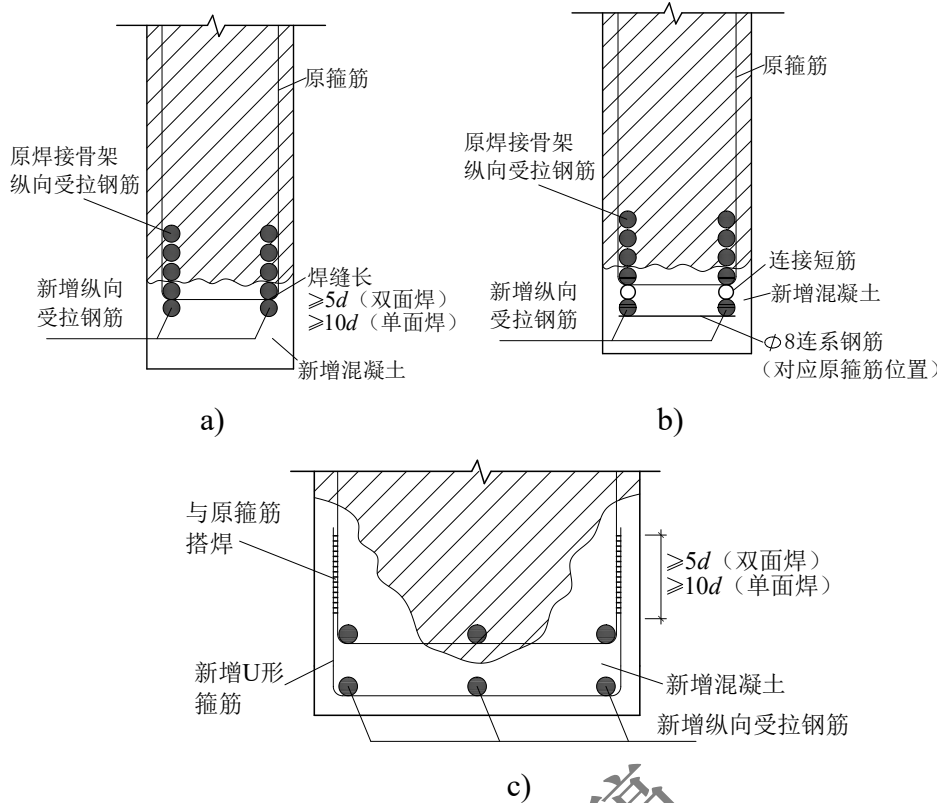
受弯构件新增纵向受拉钢筋连接构造示意图
